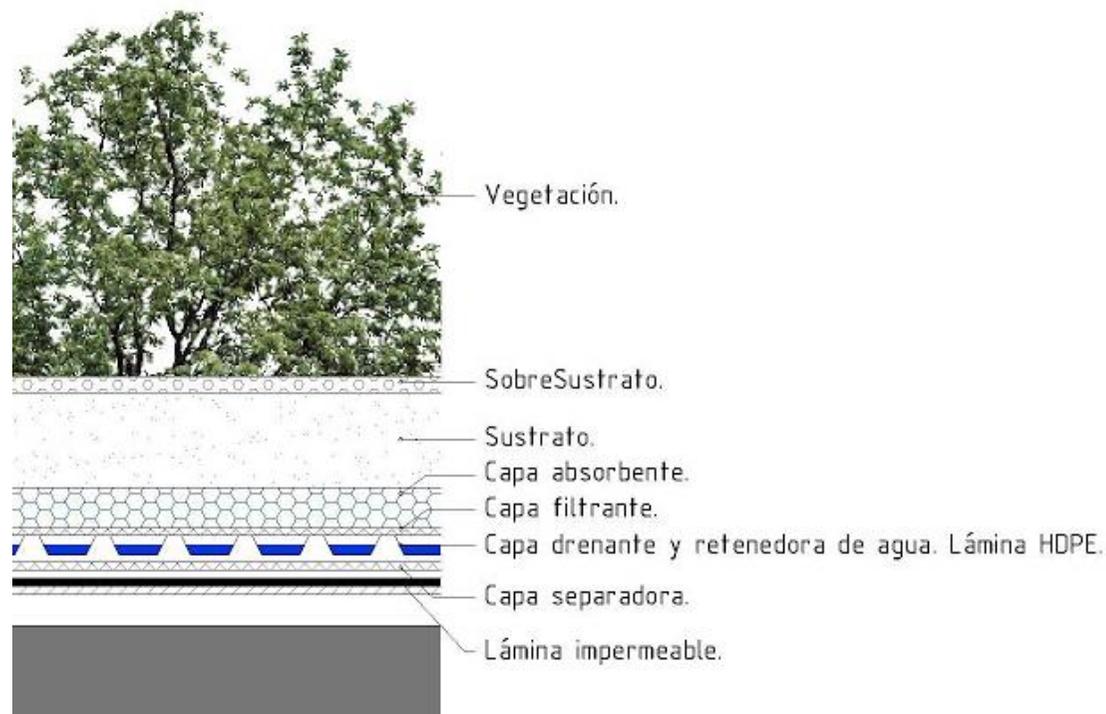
Cubierta vegetal. Sistema Constructivo
